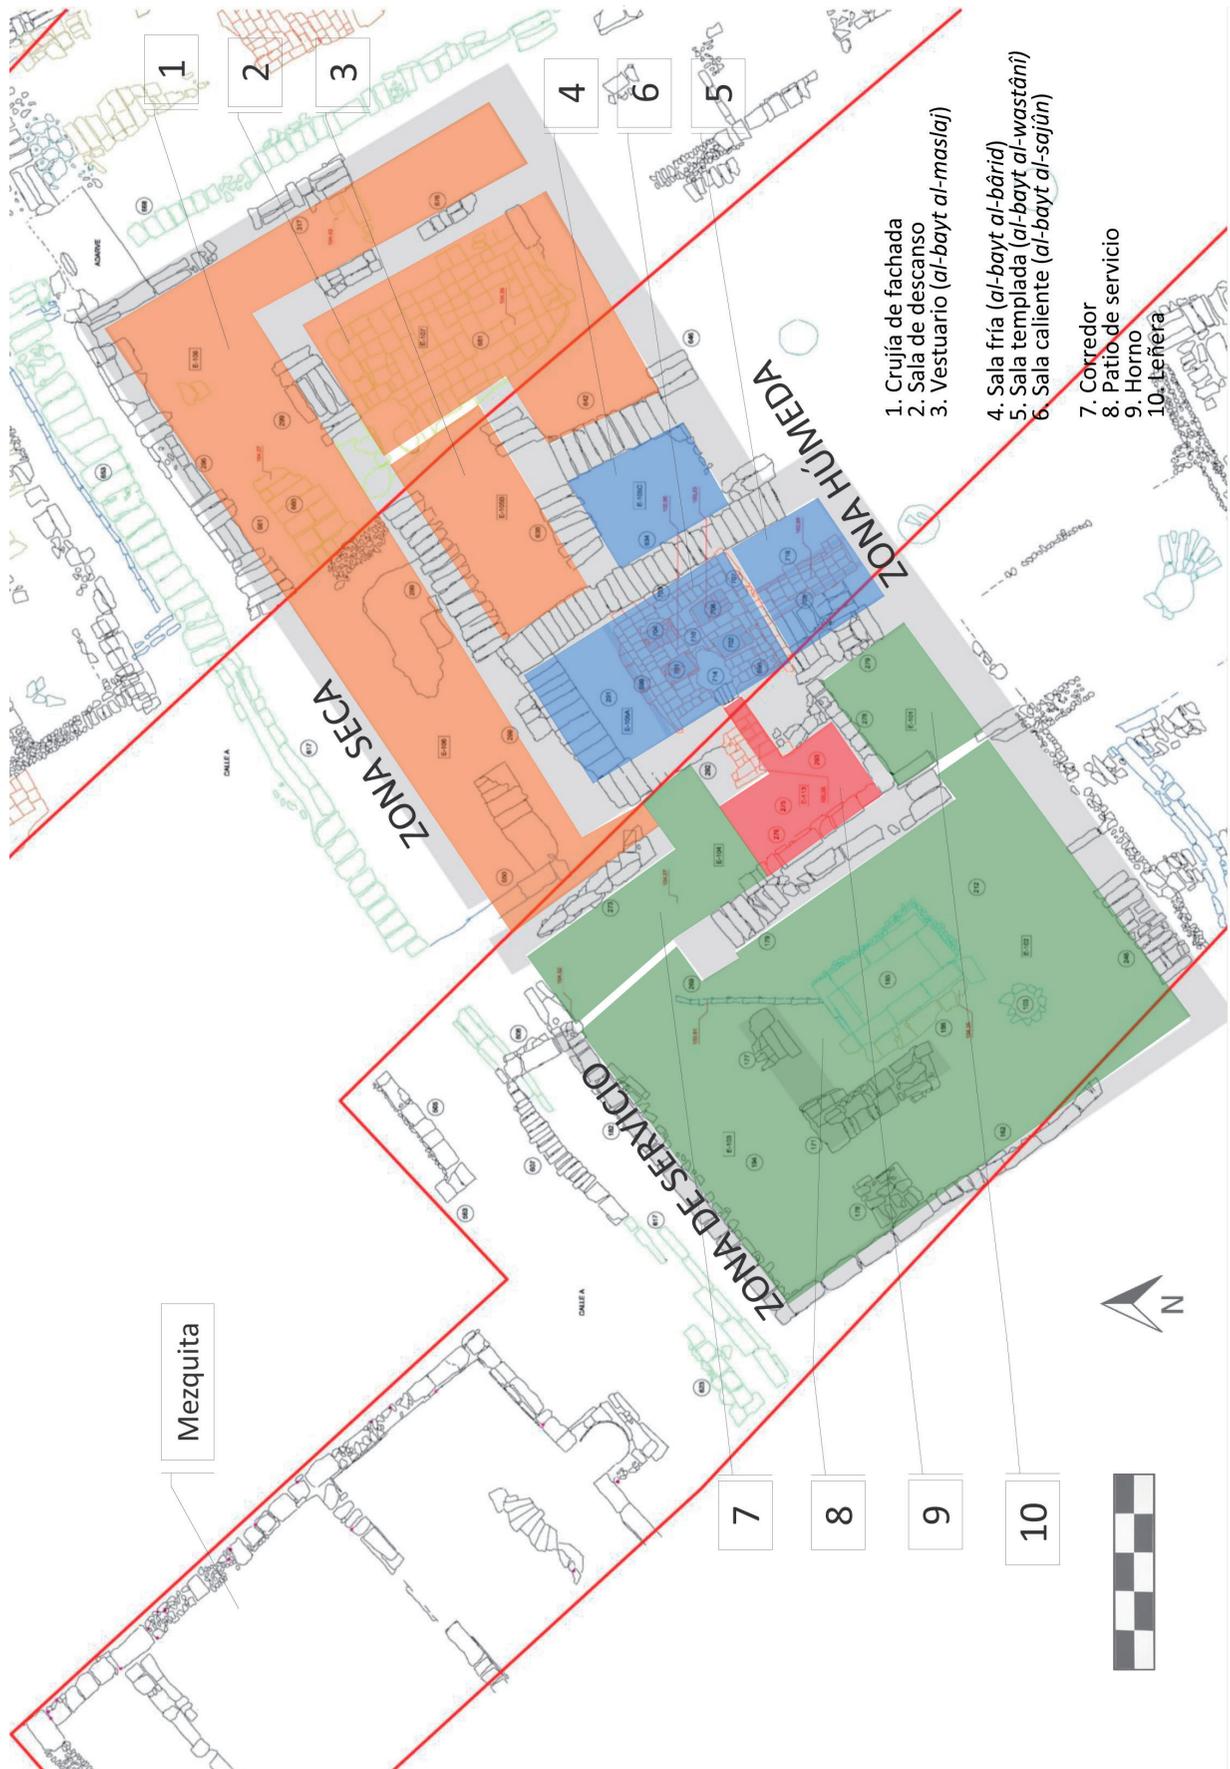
Planta sobre planimetría elaborada por César Pérez Navarro durante la Intervención.
